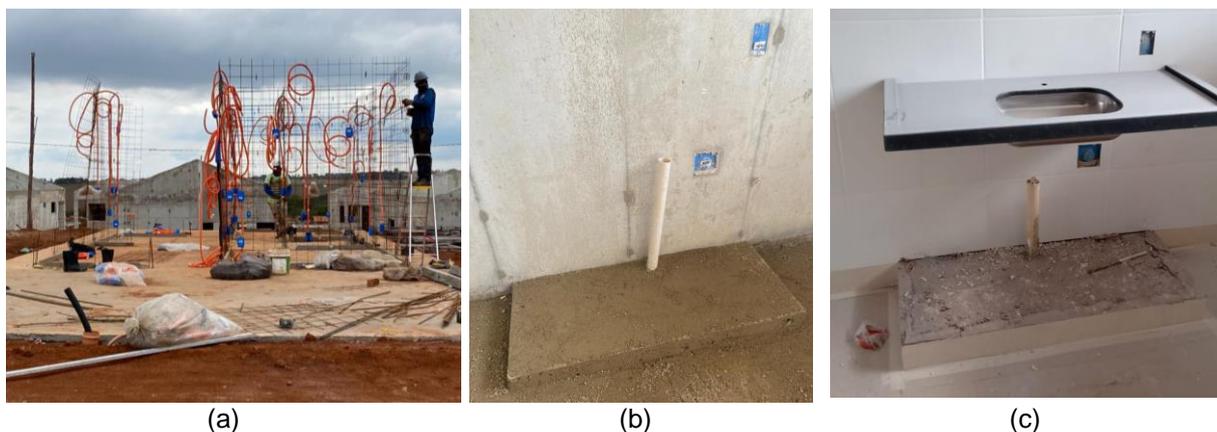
Instalações de dutos (a) execução das instalações após fixação das armações; (b) detalhe de tubulação após concretagem para pia de cozinha; (c) tubulação com pia já instalada.
